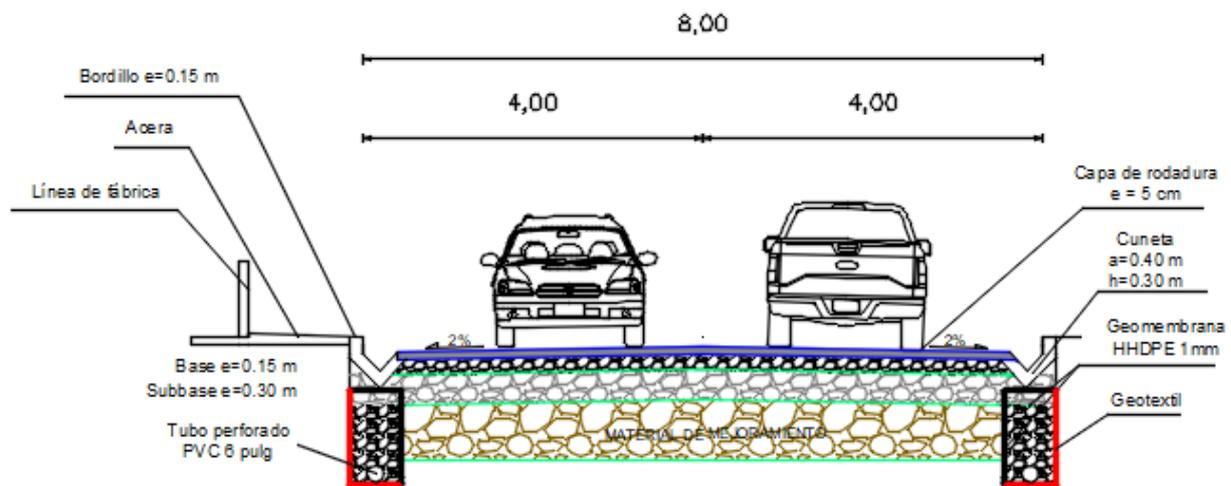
Corte refuerzo con geomembrana. Fuente: Elaboración propia
